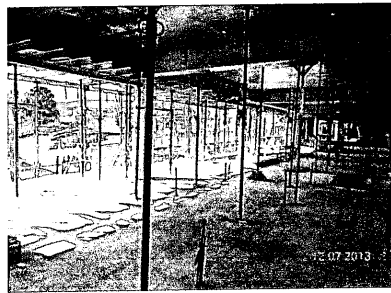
y 10 FACHADA NORTE: ZÓCALO, PRIMER Y SEGUNDO PISO
